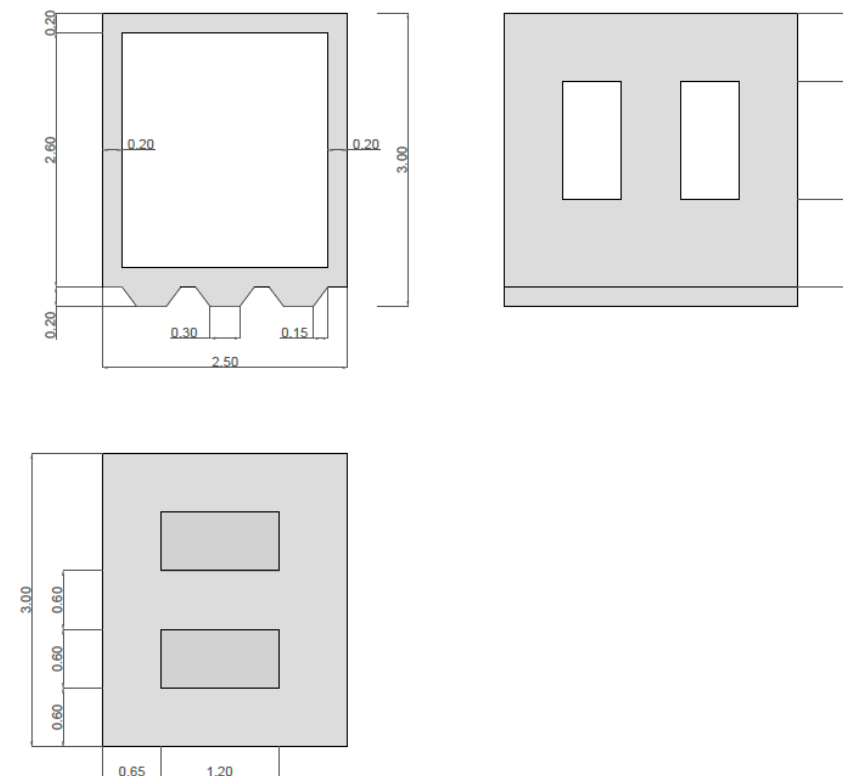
Diseño y dimensiones de las piezas. (Fuente: plano 7, 2023)
